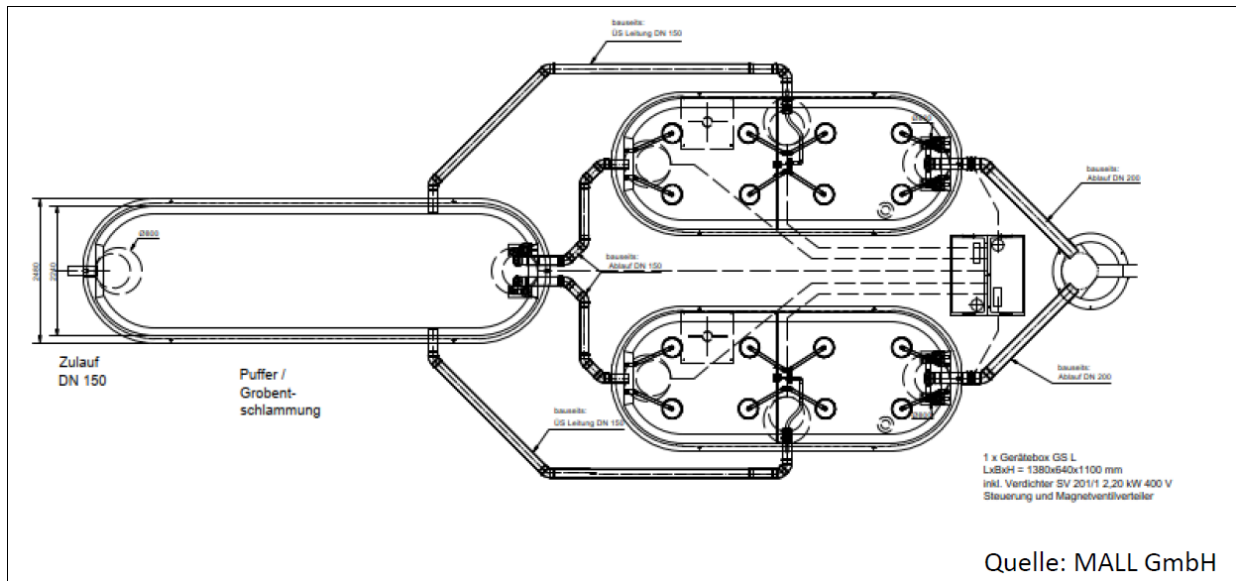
Grundriss Kleinkläranlage der Firma MALL
